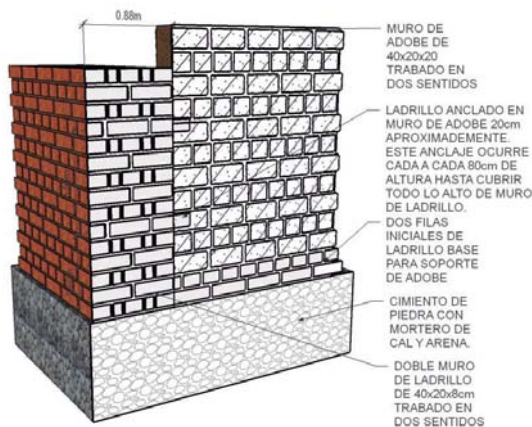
Detalle 3D de la unión de muro de ladrillo con un muro de adobe
